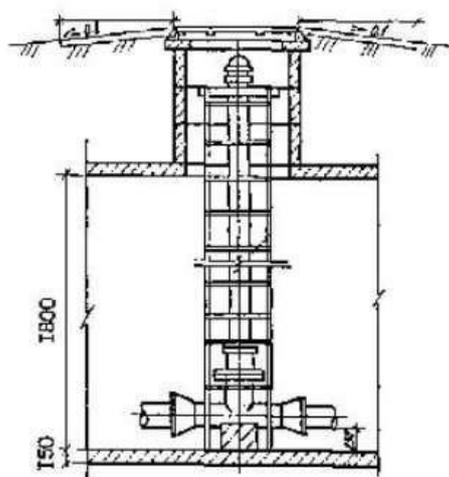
Схема установки пожарного гидранта на водопроводной сети.
